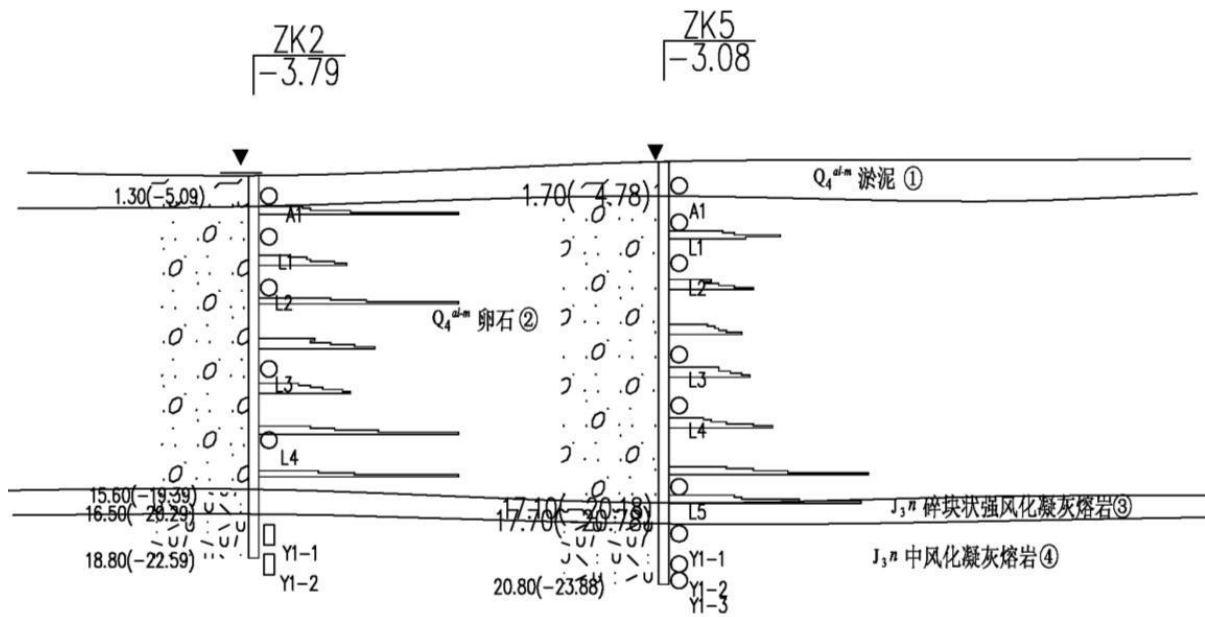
初芦陆岛交通码头工程地质剖面图 2
